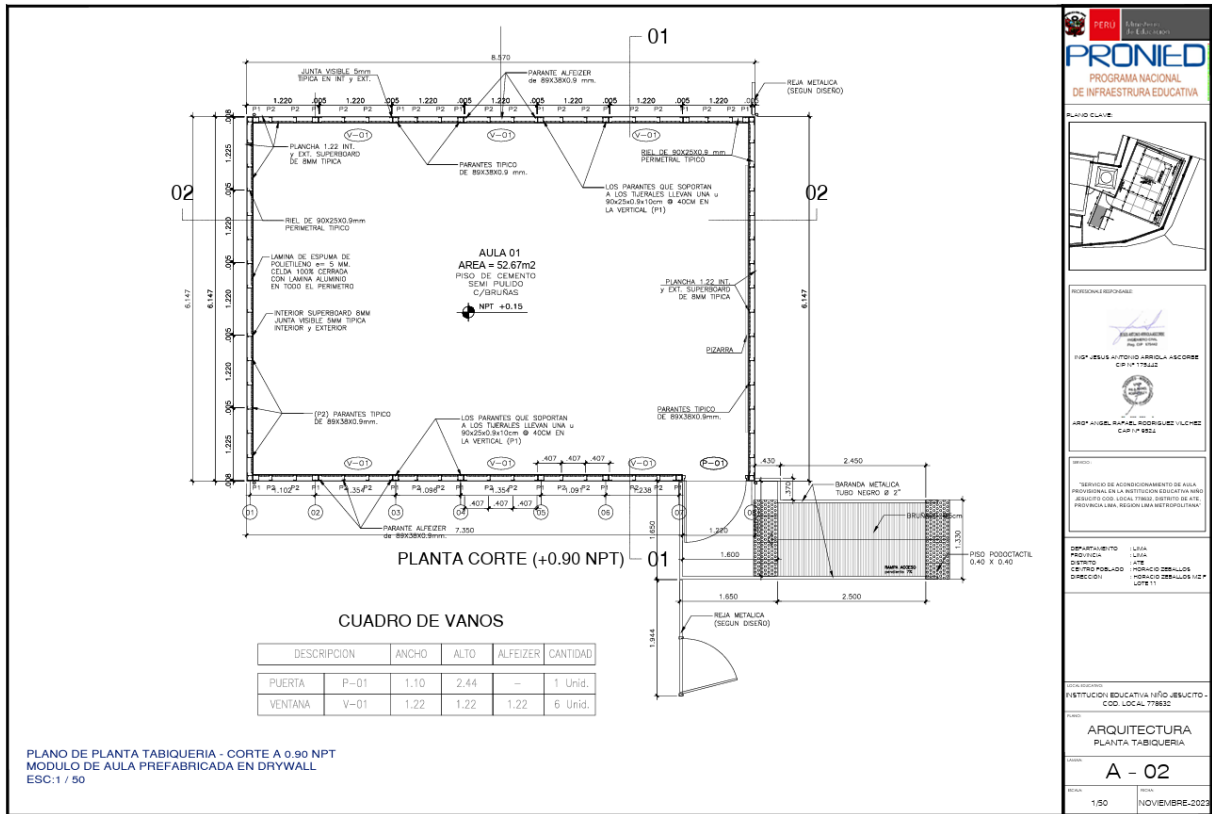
Plano de propuesta de intervención con aula provisional: Planta de tabiquería.
